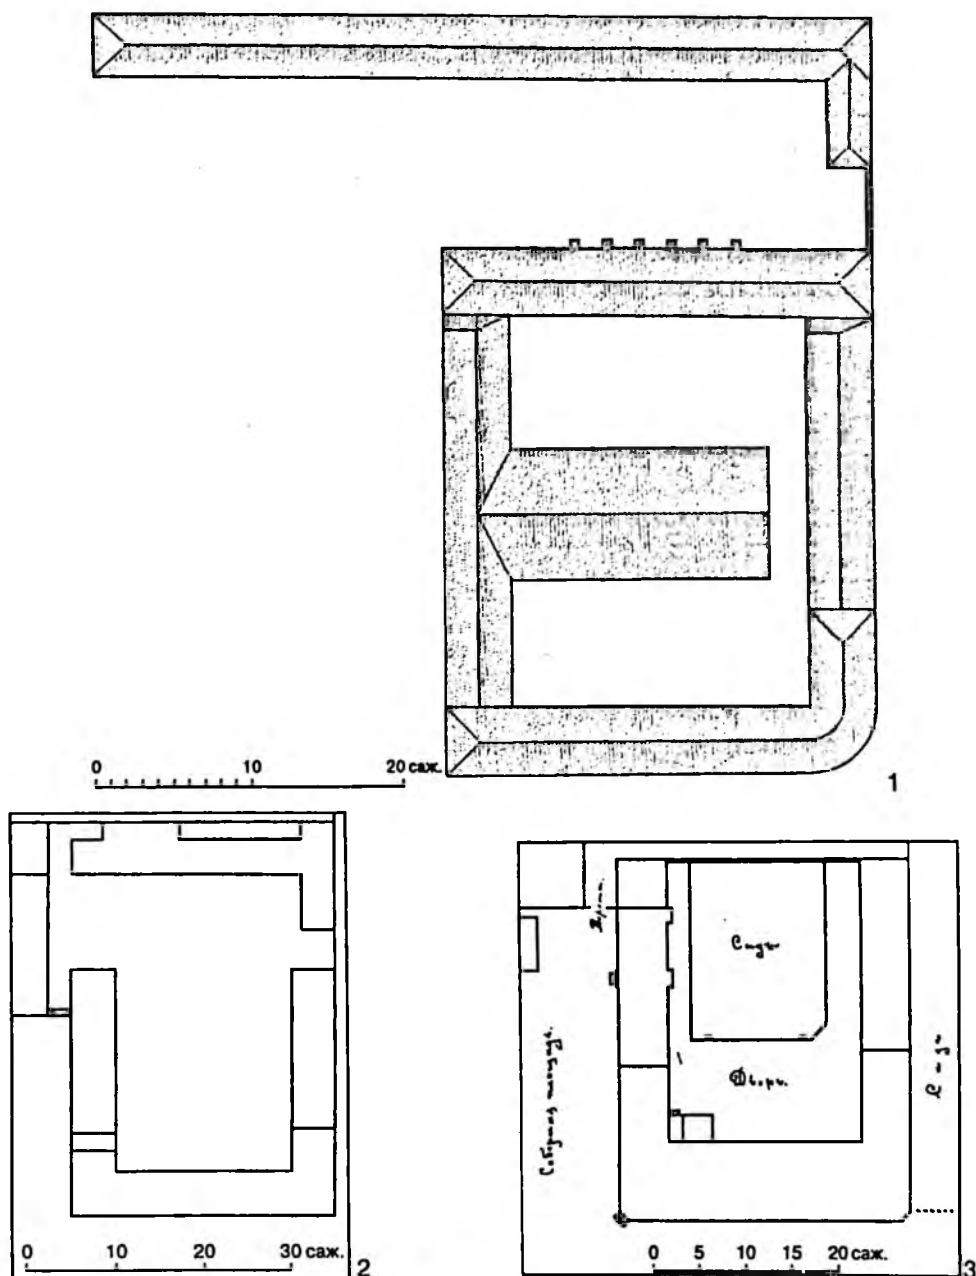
Планы построек на месте раскопа Тверской кремль-11: 1 — юнкерская школа в Твери. 1839 г. ГАТО. Ф. 97. Оп. 1. Д. 357. Л. 53; 2 — “План и фасад на сделание из сарая жилого помещения и надстройку ворот в г. Твери, 1-й части, 1-го квартала, на месте, принадлежащем Юлию Васильевичу Пиранг”. 1874 г. ГАТО. Ф. 801. Оп. 1. Д. 168-а. Л. 246 (фрагмент: общий план построек); 3 — “Генеральный план местности занимаемой Реальным училищем в городе Твери”. 1909 г. ГАТО. Ф. 801. Оп. 1. Д. 3567.
